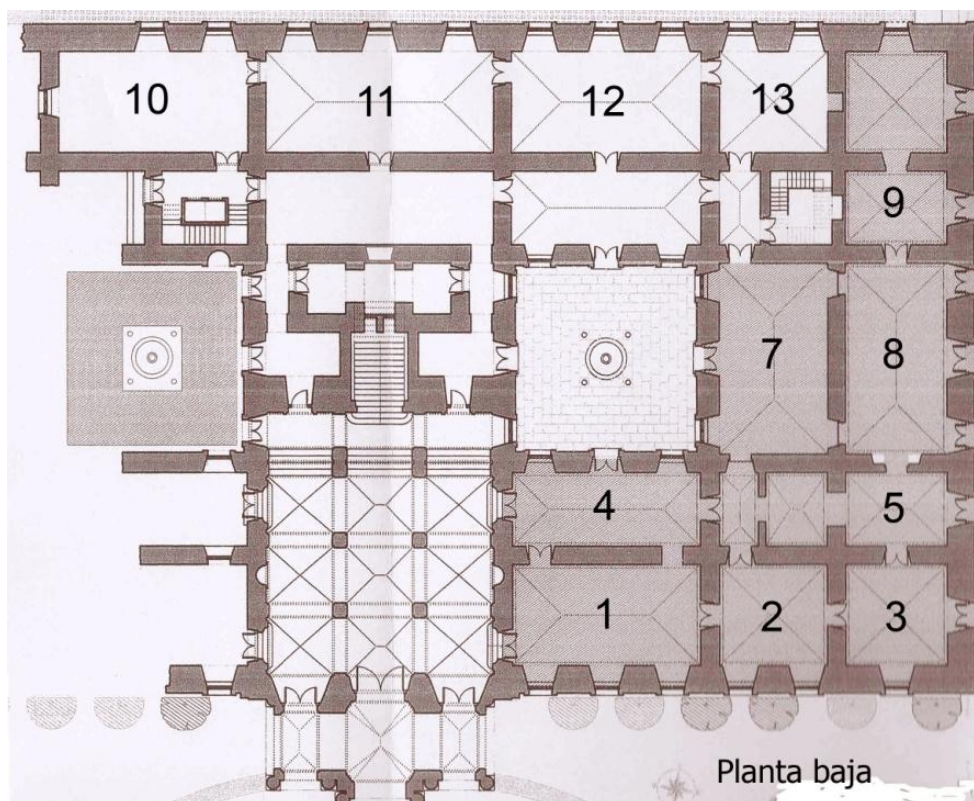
Planta Baja del Palacio de la Mosquera. Plano personalizado a partir del diseño realizado para el Plan Director.
